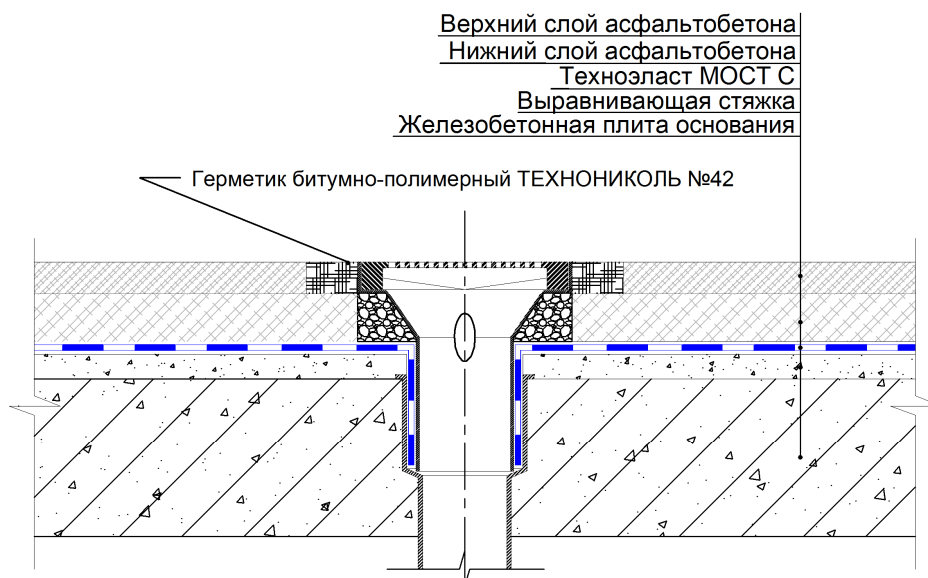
Сопряжение гидроизоляции с водоотводной трубкой.
